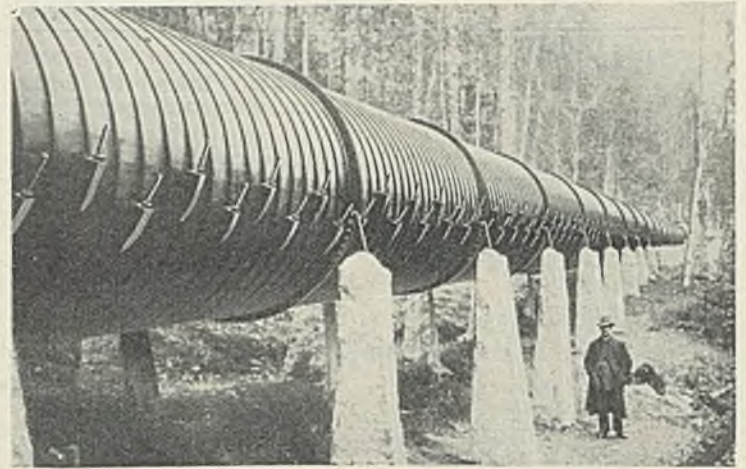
Weitspannröhreleitung aus Holzdauben für das schwedische Kraftwerk Lindesnäs: 1,7 m l. W., 4,0 m Stützenabstand, 2,5" Daubenstärke (Vattenbyggnadsbyran, Stockholm).
